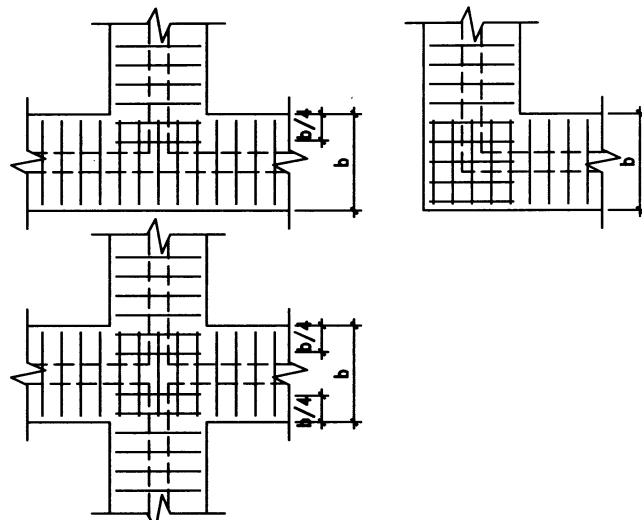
钢筋混凝土条形基础底板受力钢筋布置示意
